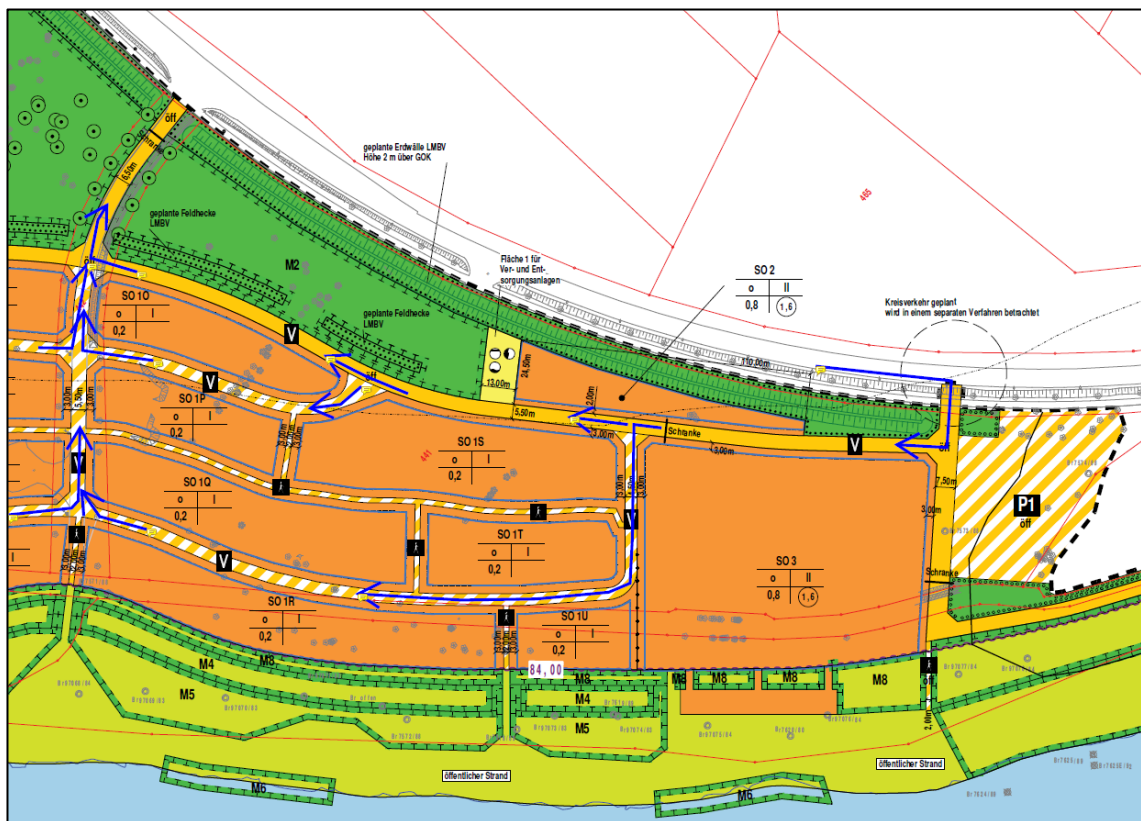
Ausschnitt Planzeichnung mit Kennzeichnung der Zu- und Abfahrten
